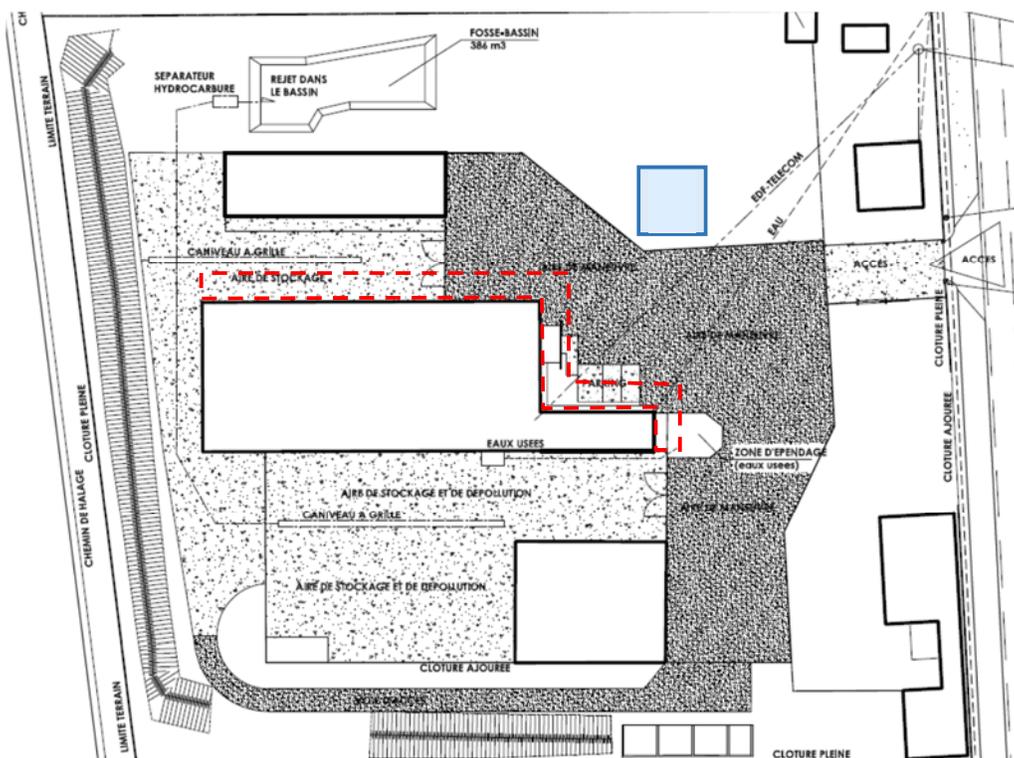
Emplacement de la voie échelle (en rouge) et de la cuve à eau souple (en bleu)
